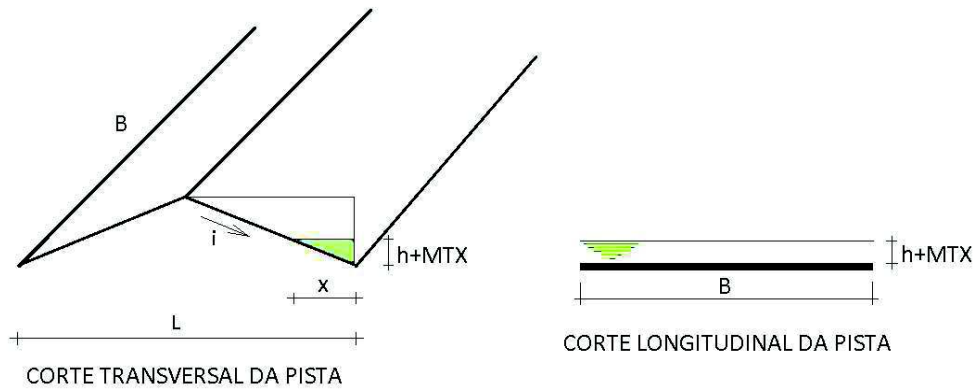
Cortes transversal e longitudinal de uma seção de pista de pouso e decolagem.
